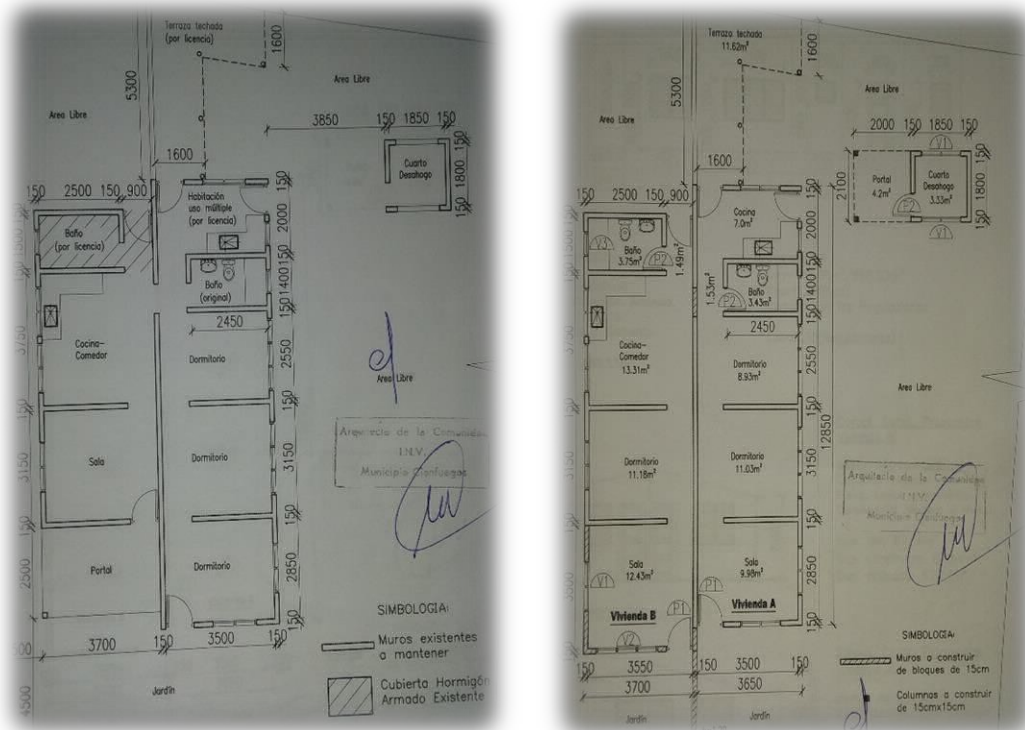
Modelo de la vivienda. Planta actual en ejecución a la izquierda y Planta propuesta a la derecha.
